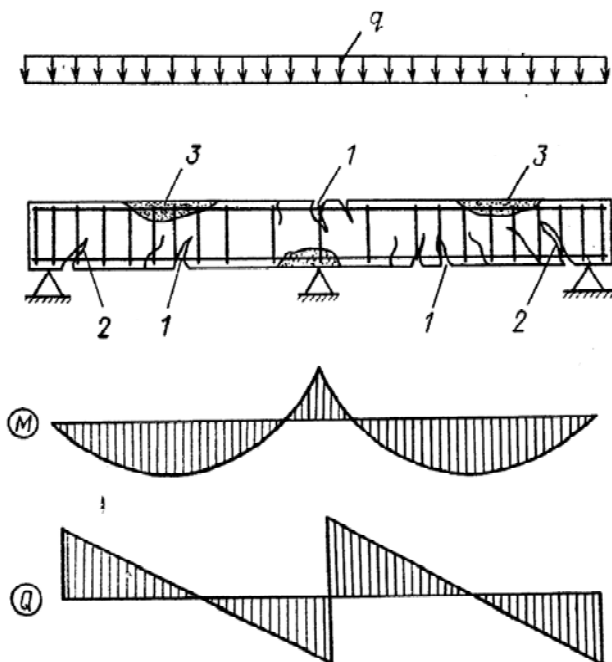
Характерные трещины в изгибаемых железобетонных элементах, работающих по балочной схеме:
